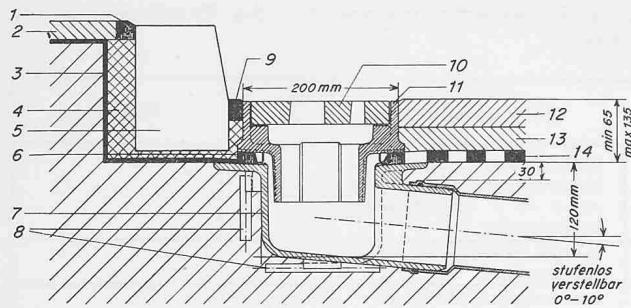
Einlaufschacht Honel 307/D. 1 Gussmasse, 2 Gussasphalt, 3 Bitumengewebefahrbahn «Mastix», 4 Zementmörtel, 5 Bordstein, 6 Kittkeil, 7 Schachttasse, 8 Montageeisen, 9 Kittfuge, 10 Rost, 11 Schachtrahmen, 12 Fahrbahndecke AB-10, 13 Fahrbahndecke AB-16, 14 Isolation
